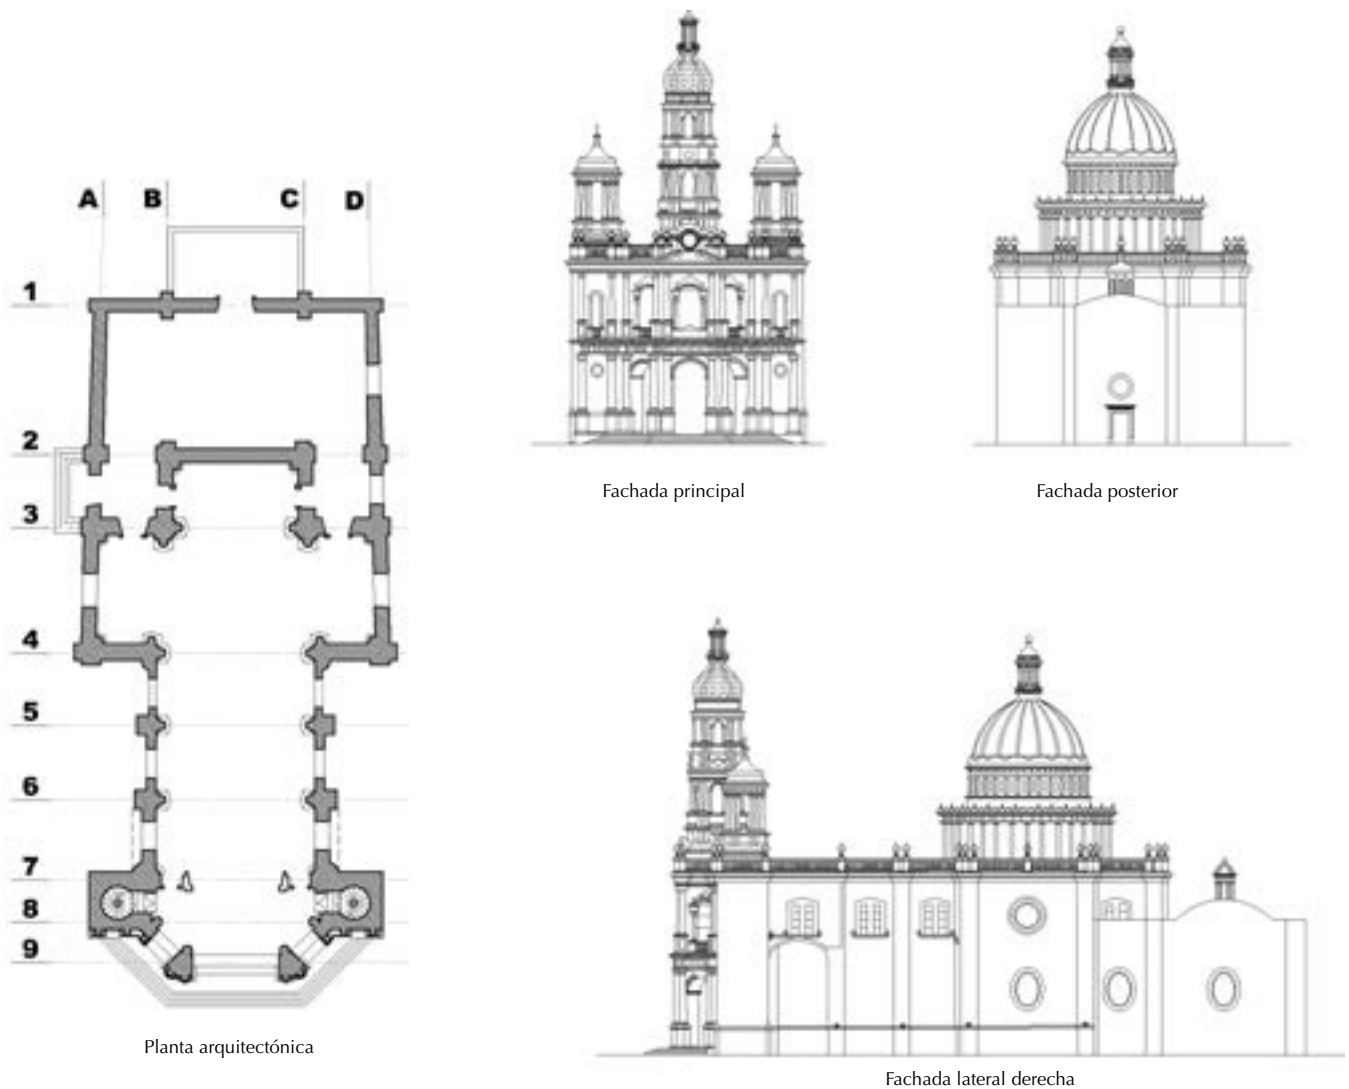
Detalles arquitectónicos del templo de San Antonio de Padua; planta arquitectónica, fachada principal, posterior y lateral (Ilustración: Edith Orenday-Tapia, 2019; fuente: M. Navarro 2013).
